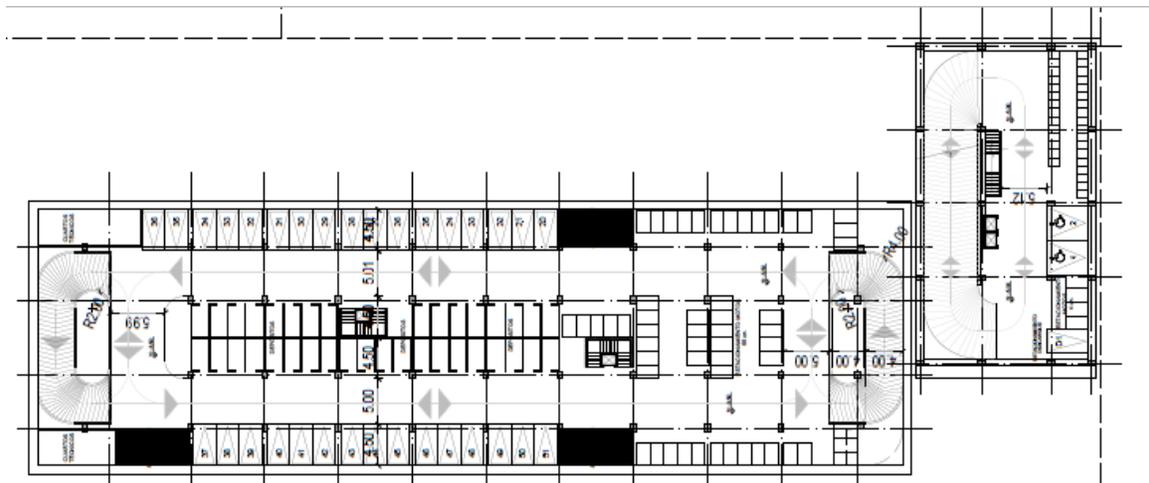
PF13. Planta Eestacionamientos – Sótano 1
